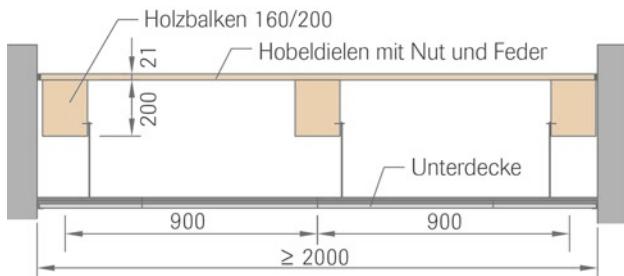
Unterdecken-Konstruktion Holzbalken. (OWA Odenwald Faserplattenwerk GmbH)
